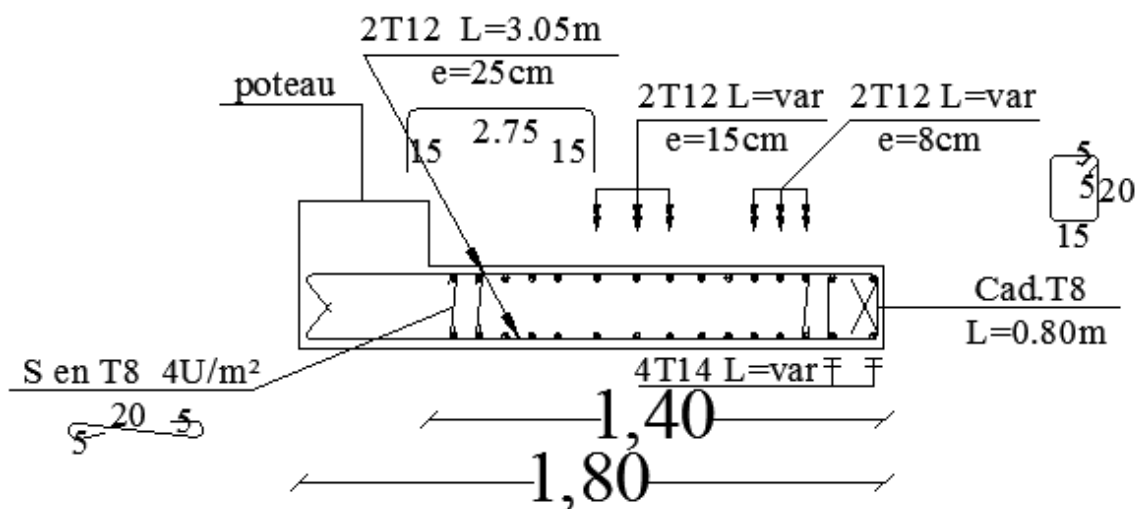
schémas de ferrailages des voiles longitudinaux
